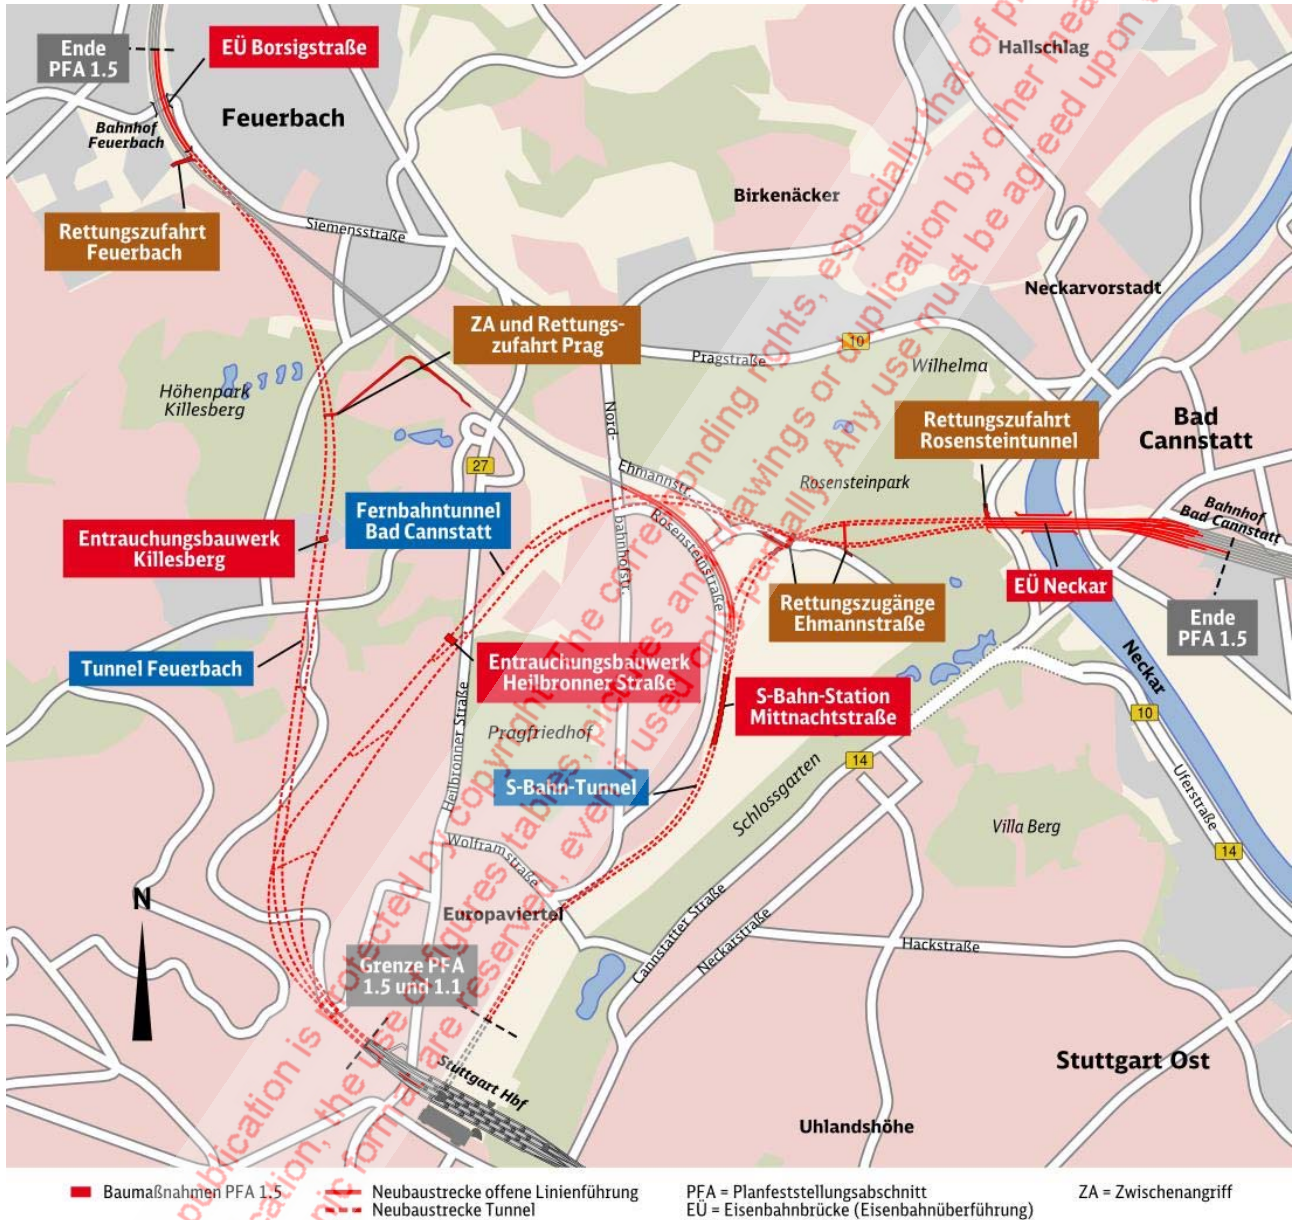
Planfeststellungsabschnitt PFA 1.5 - Übersicht
